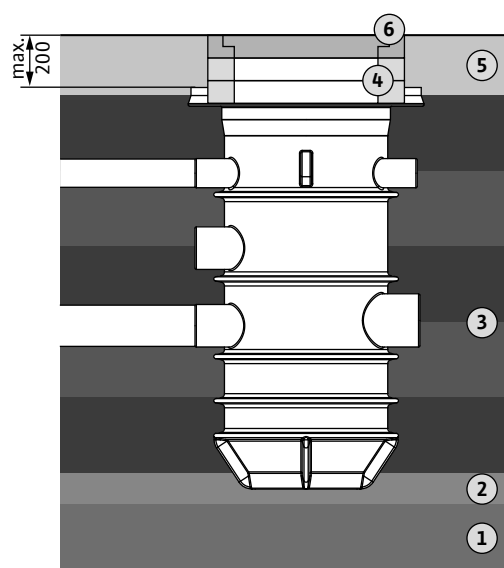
Remblayer la fosse (avec couvercle de fosse D400)
